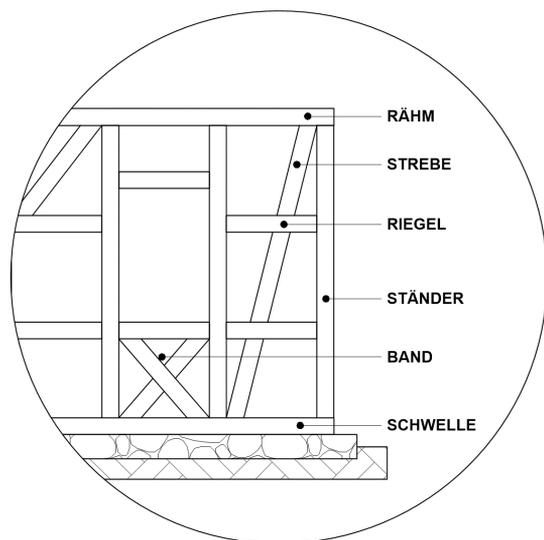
Wichtige Holzelemente der Fachwerkstruktur mit ihren Fachbezeichnungen nach Gerner 2011, S.105 (Quelle: Sarah Belke)
